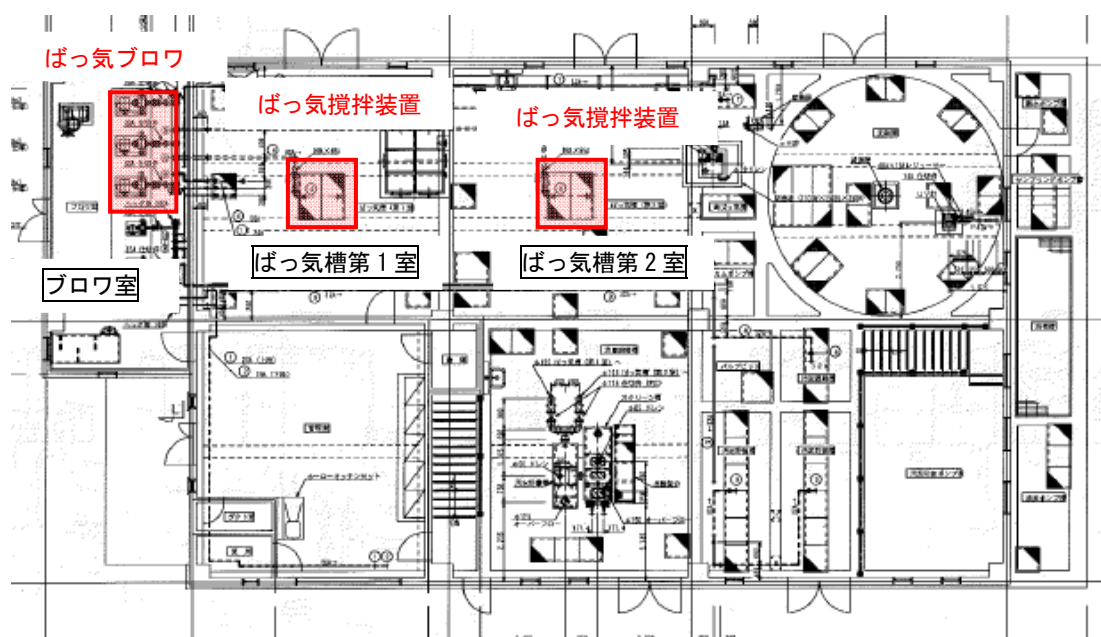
檜崎地区 設備平面図 ※ 赤字は省エネ対象機器
